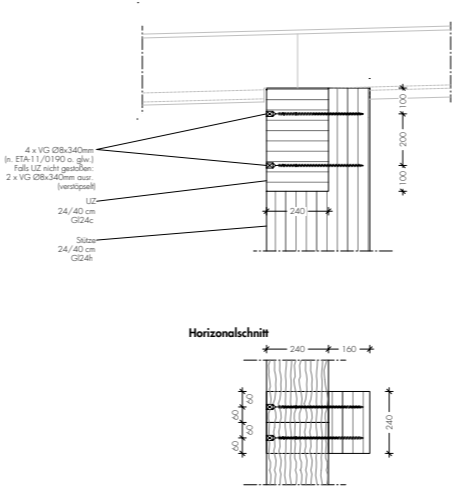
Anschluss Kragträger VD1 an S401 - E4
